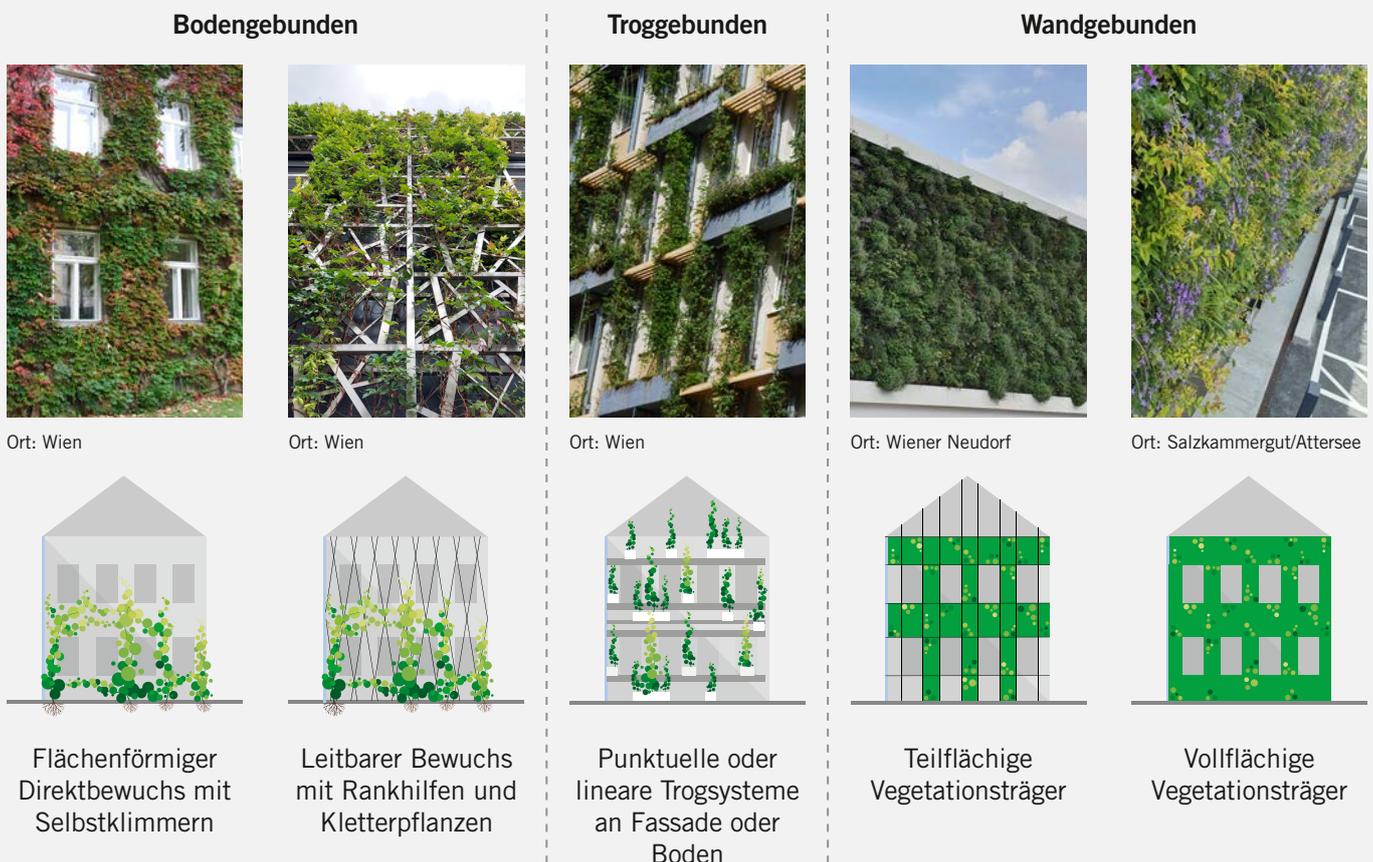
Kategorien der Fassadenbegrünung © GRÜNSTATTTGRAU, Schöberl, Dachgrün
